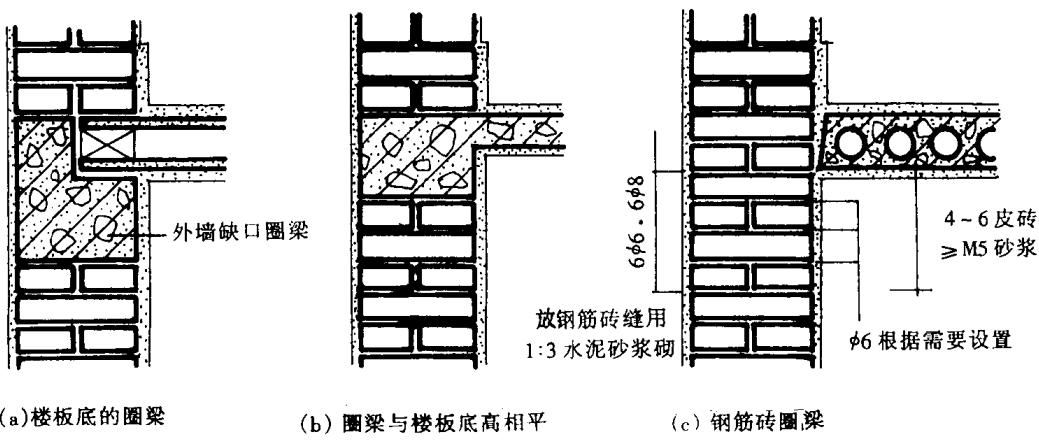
钢筋砖圈梁和钢筋混凝土圈梁
